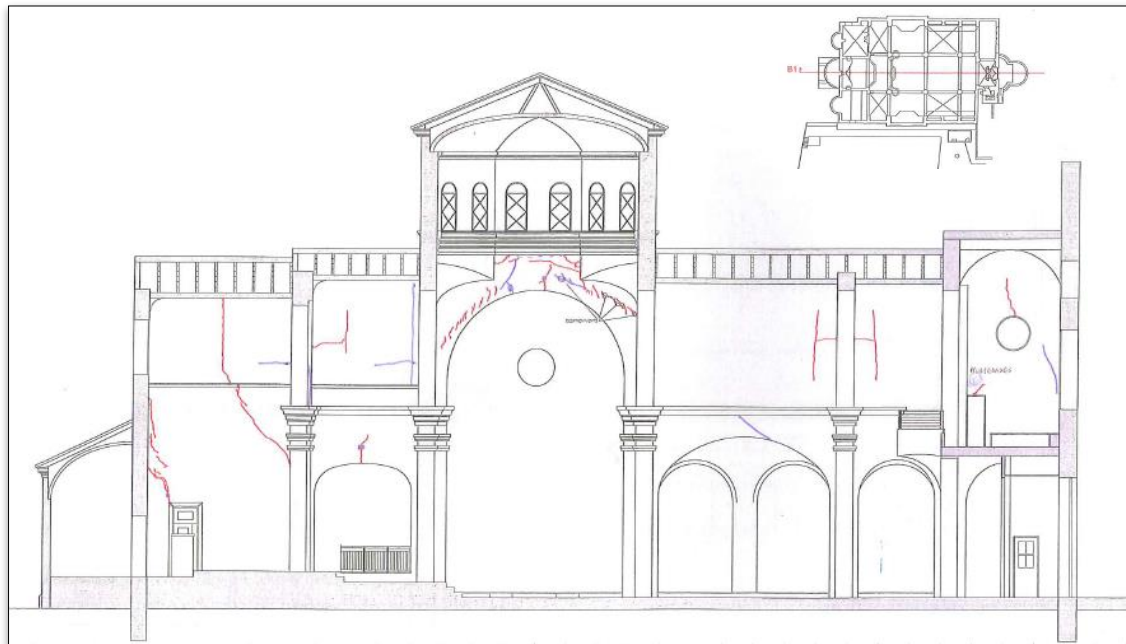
Grietas sección longitudinal central (plano PAT. 05)
